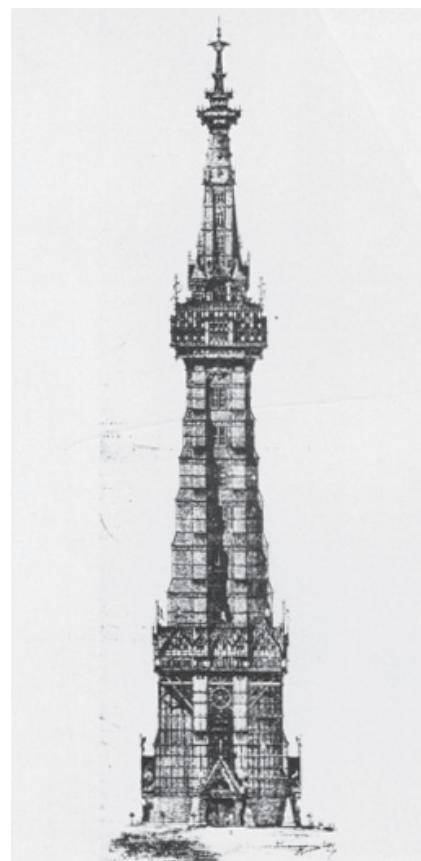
François Hennebique, Progetto di una Torre per l'esposizione di Bruxelles del 1888. Prospettiva.
